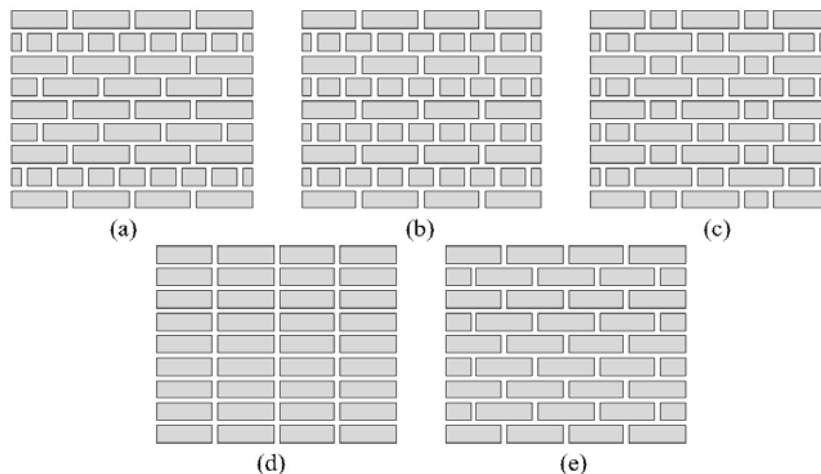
Tipos de disposição da alvenaria de tijolos/blocos: Ligação (a) Americana; (b) Inglesa (ou cruzada); (c) Flamengo; (d) Tipo monte; (e) Alternada (ou comum) [21]
